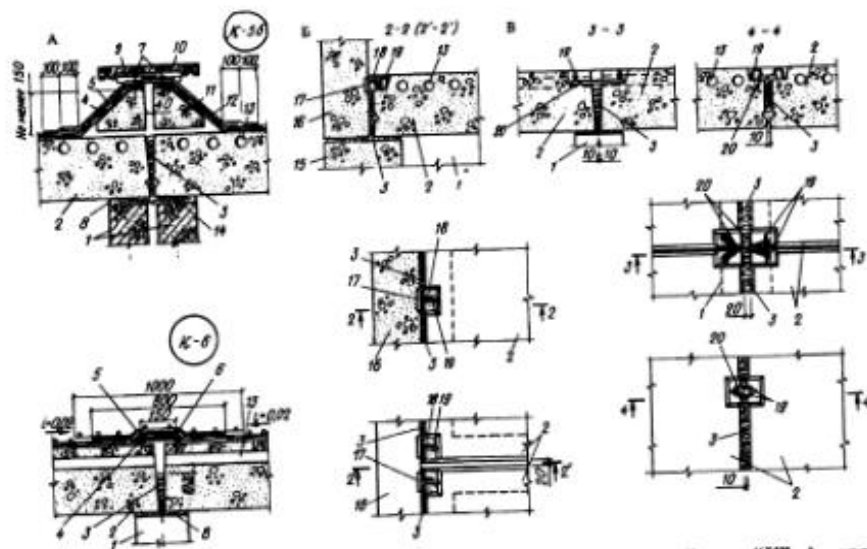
Бесчердачная вентилируемая крыша из легкобетонных панелей типа "К": А – узлы К-5б, К-6; Б, В – сопряжения панелей покрытия с парапетом и между собой; 1 – стена внутренняя; 2 – легкобетонная кровельная панель с вентиляционными каналами; 3 – минераловатный войлок; 4 – защитная обмазка водонизоляционным составом; 5 – два дополнительных слоя рубероида на битумной мастике; 6 – плоская асбестоцементная плитка; 7 – дюбели; 8 – цементно-песчаный раствор; 9 – листы из оцинкованной кровельной стали; 10 – парапетная плита; 11 – бетонный бортовой камень; 12 – защитная покраска водонизоляционным составом; 13 – вентиляционный канал панели; 14 – нижний компенсатор из кровельной оцинкованной стали; 15 – наружная стена из крупных блоков; 16 – парапетный блок; 17 – закладная деталь; 18 – стальная накладка; 19 – петлевой арматурный выпуск; 20 – скрутка из стальной проволоки
